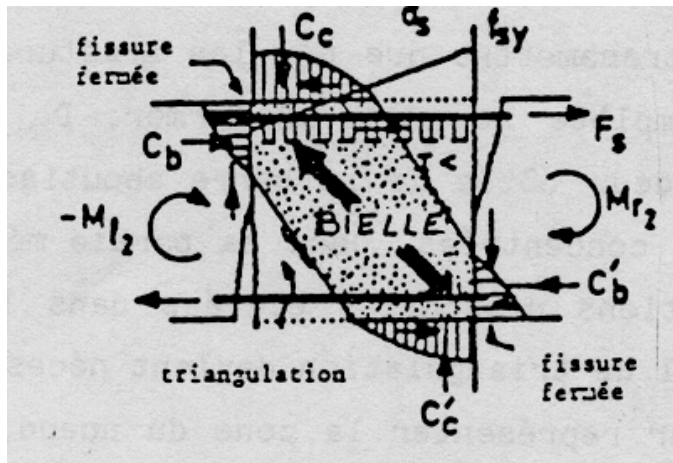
a) Bielle de compression développée au nœud poutre poteau.
